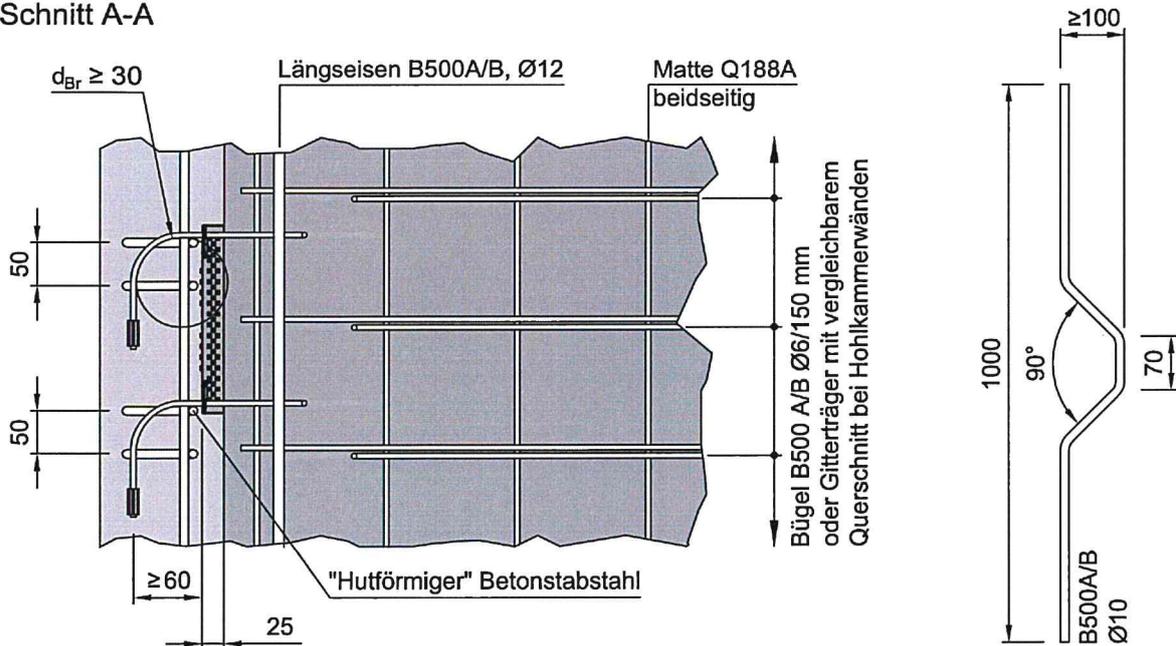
T-Verbindung mit abgewinkelten Seilschlaufen, Abmessungen, Bewehrung
